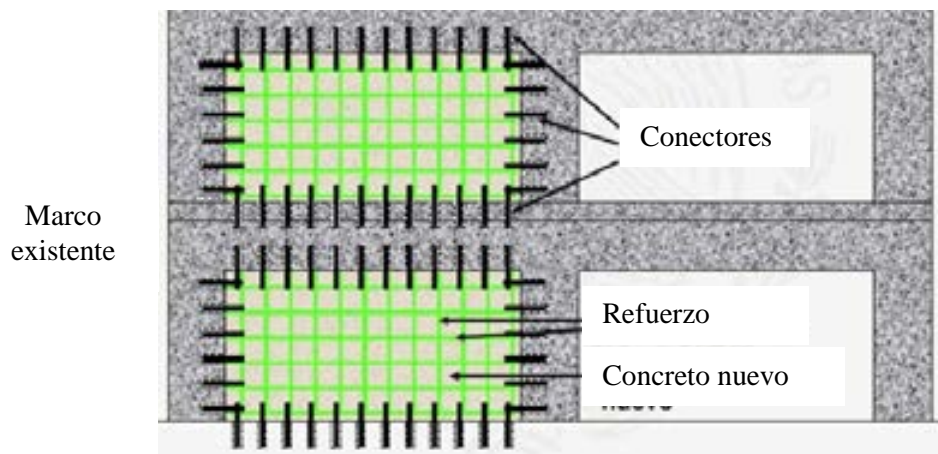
Anclas para unir elementos de concreto (Terán A., 2009)
